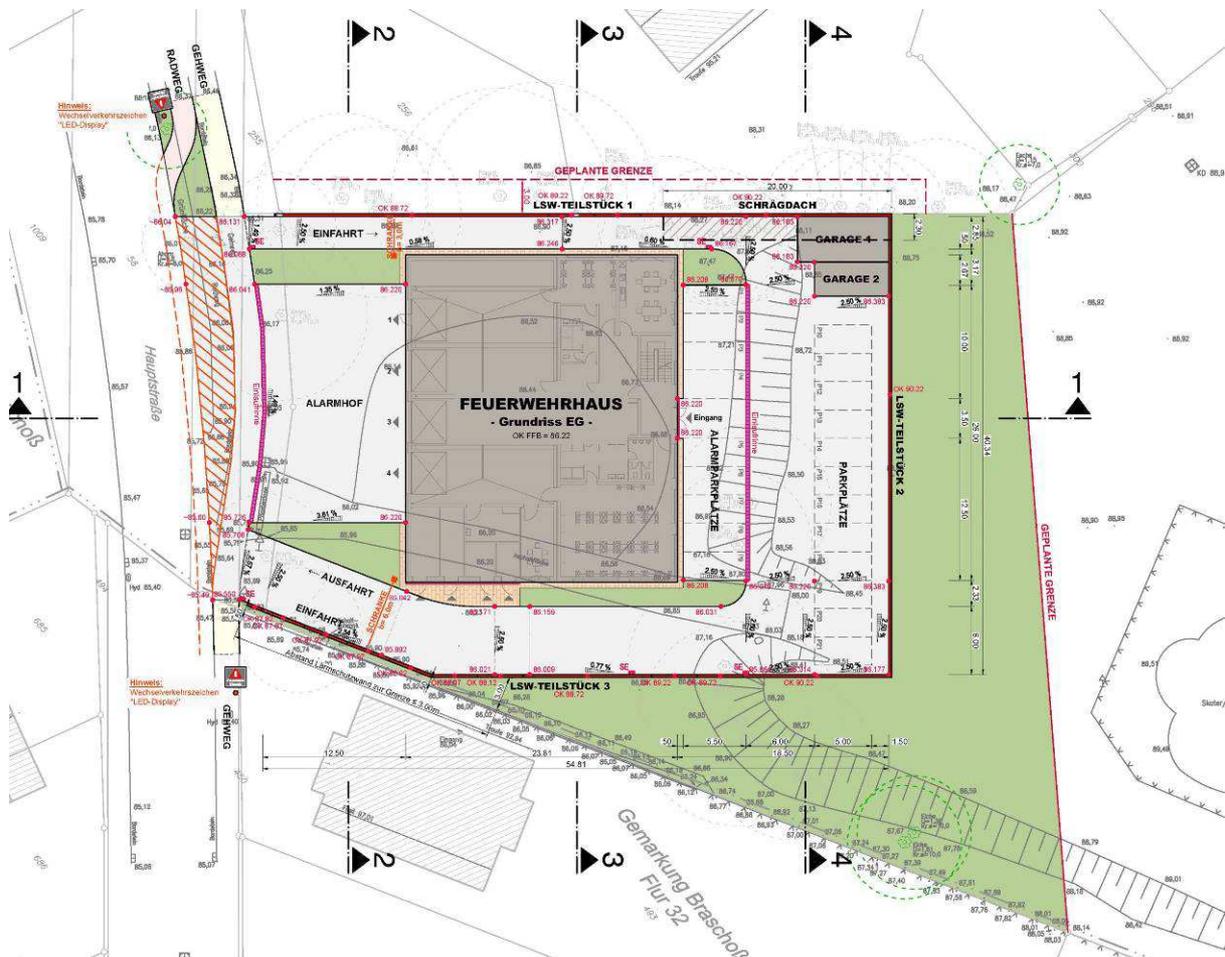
Lageplan (Entwurfsplanung, Stand 14.09.2017, kplan AG)
